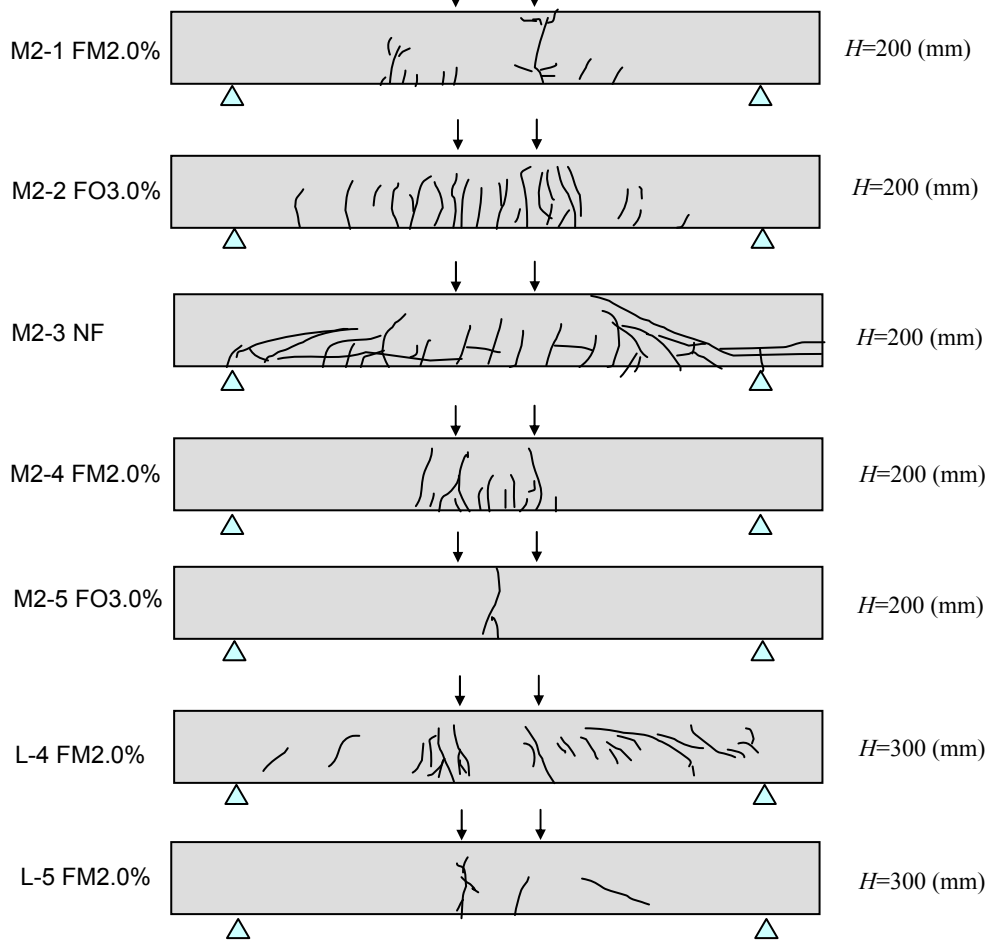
ひび割れ性状 (R-UFC はり部材の曲げ試験)
